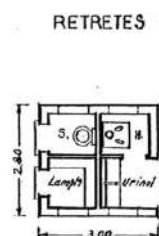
Planta da Retrete Adaptado do Anexo VI. 1952<sup>359</sup>
